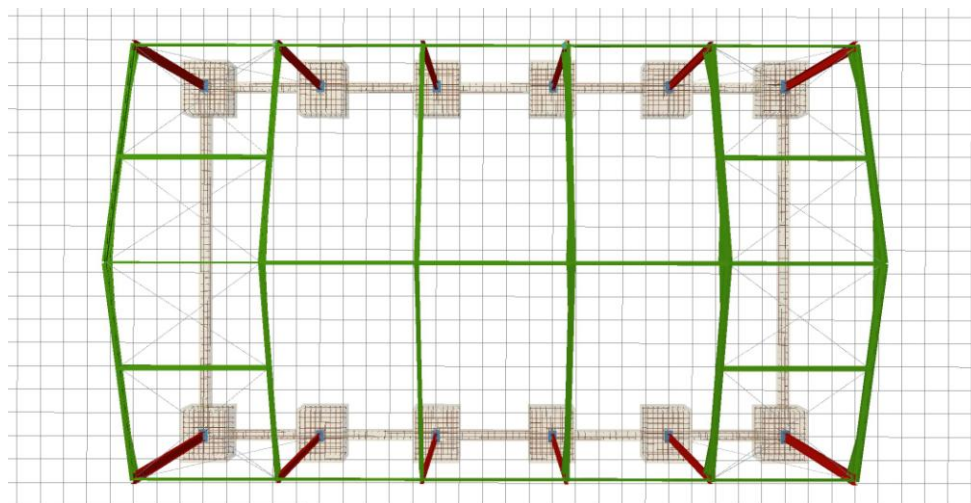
,2,3: Vistas de las estructura 3D de la nave. Fuente: Cype 3D.
